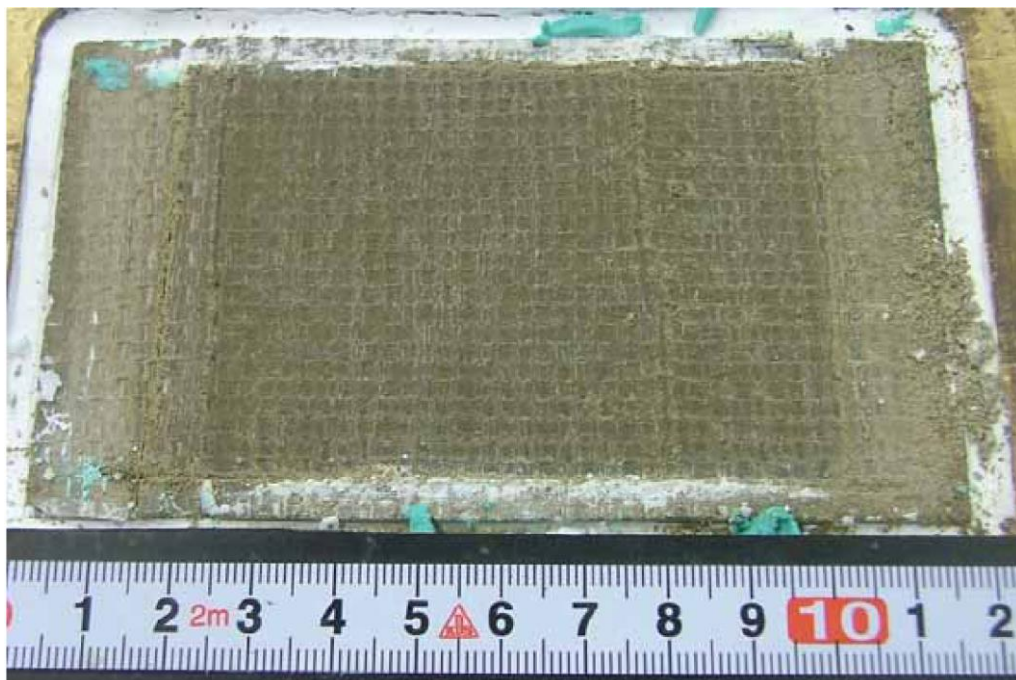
一方向載荷試験 一方向載荷試験後の供試体状況
